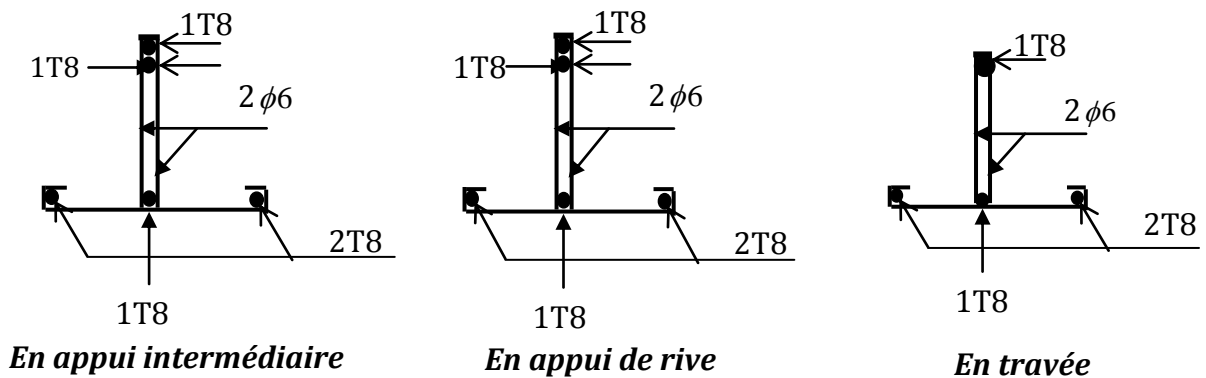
Schémas de Ferrailage des Poutrelles de la terrasse inaccessible
